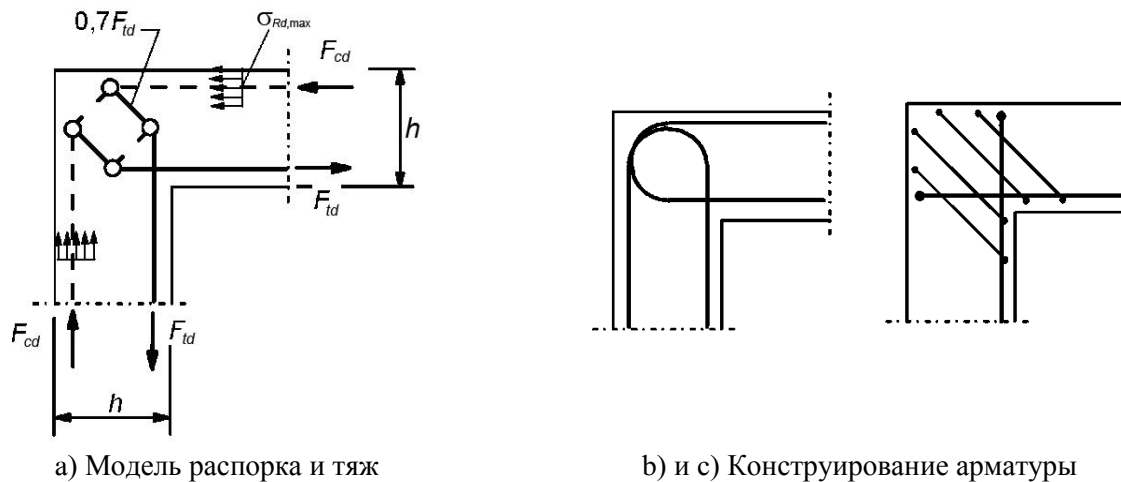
Угол рамы с умеренным раскрывающим моментом
